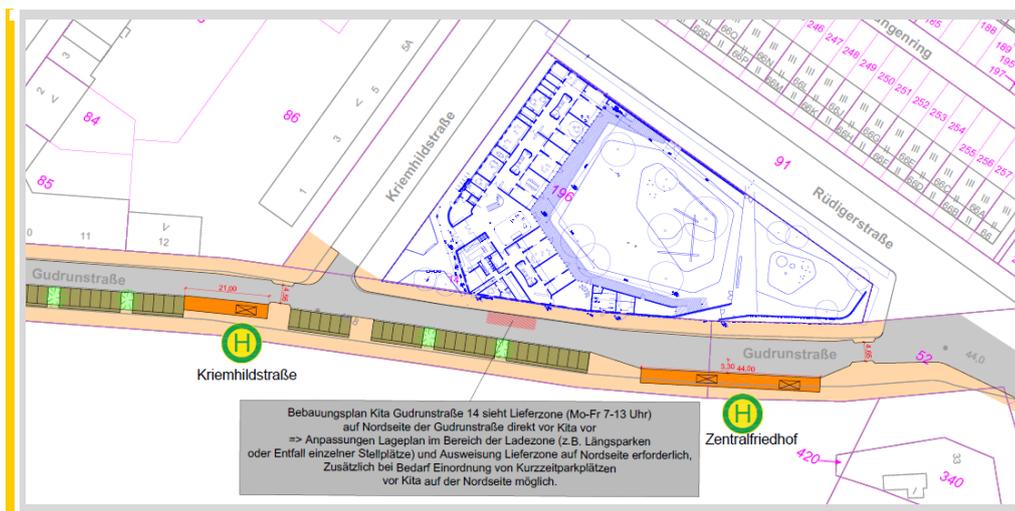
Lageplan Gudrunstraße Bereich Kriemhildstraße/Rüdigerstraße
